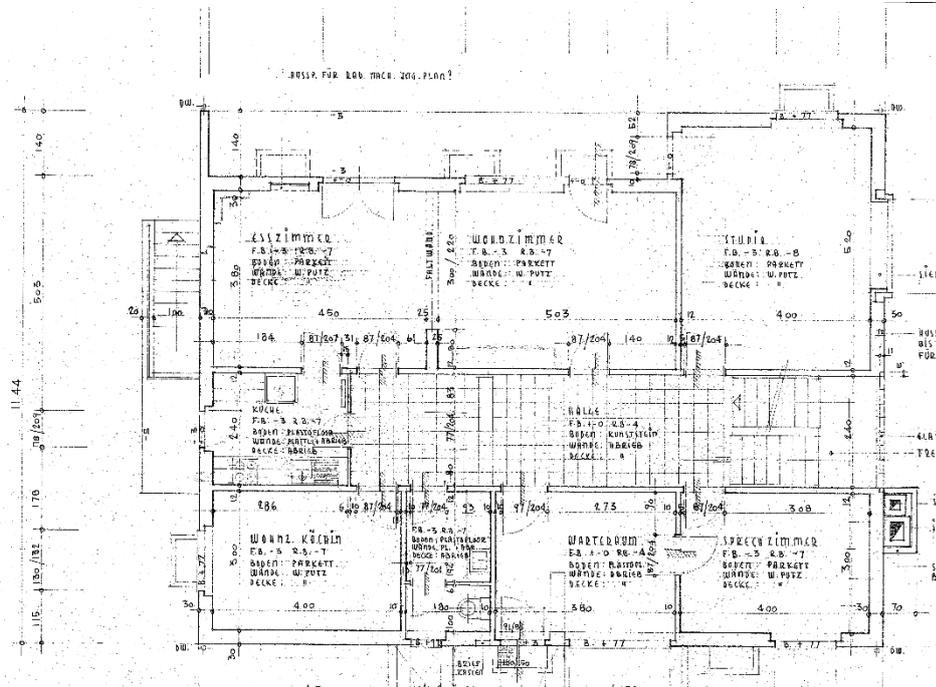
Pfarrhaus Kestenholz / Grundriss EG
